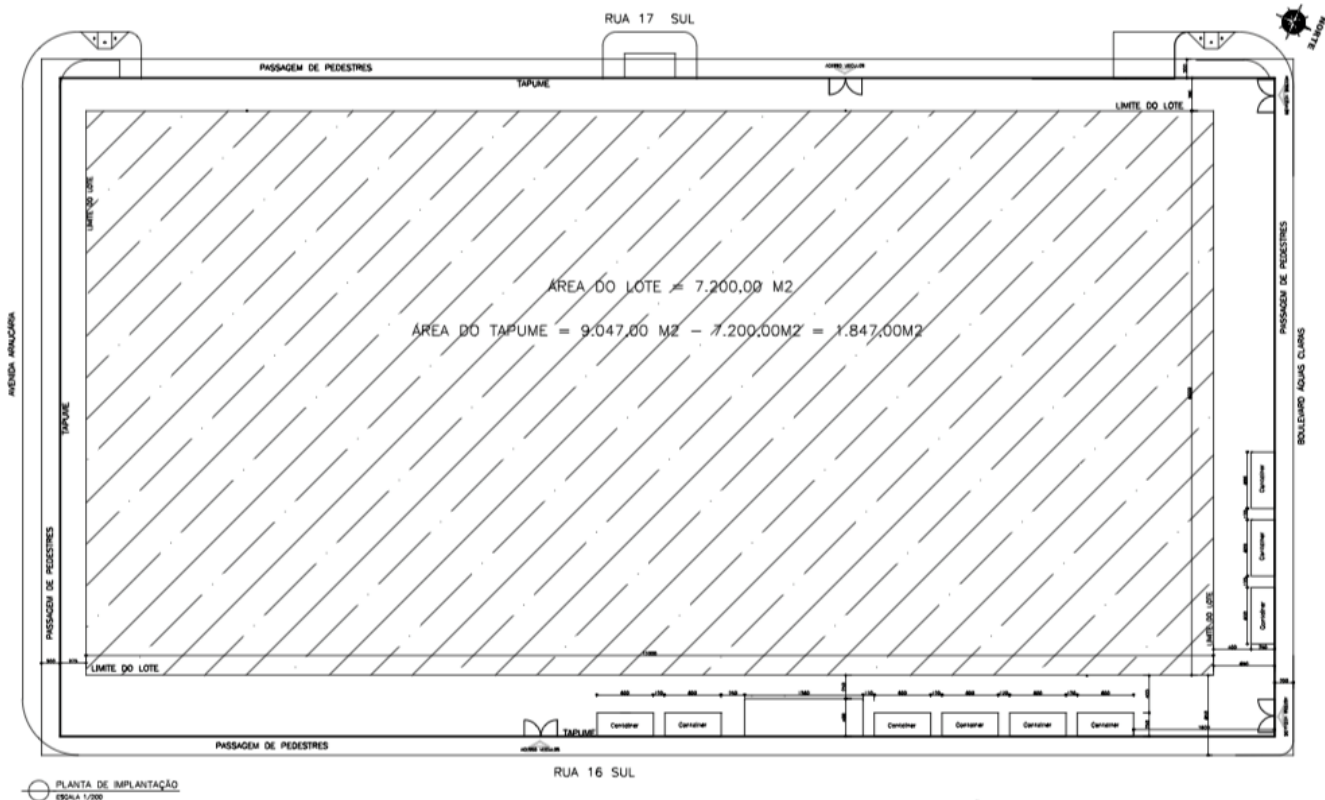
Planta do Canteiro de Obras informado no EIV. Planta tapume canteiro - 32195524
